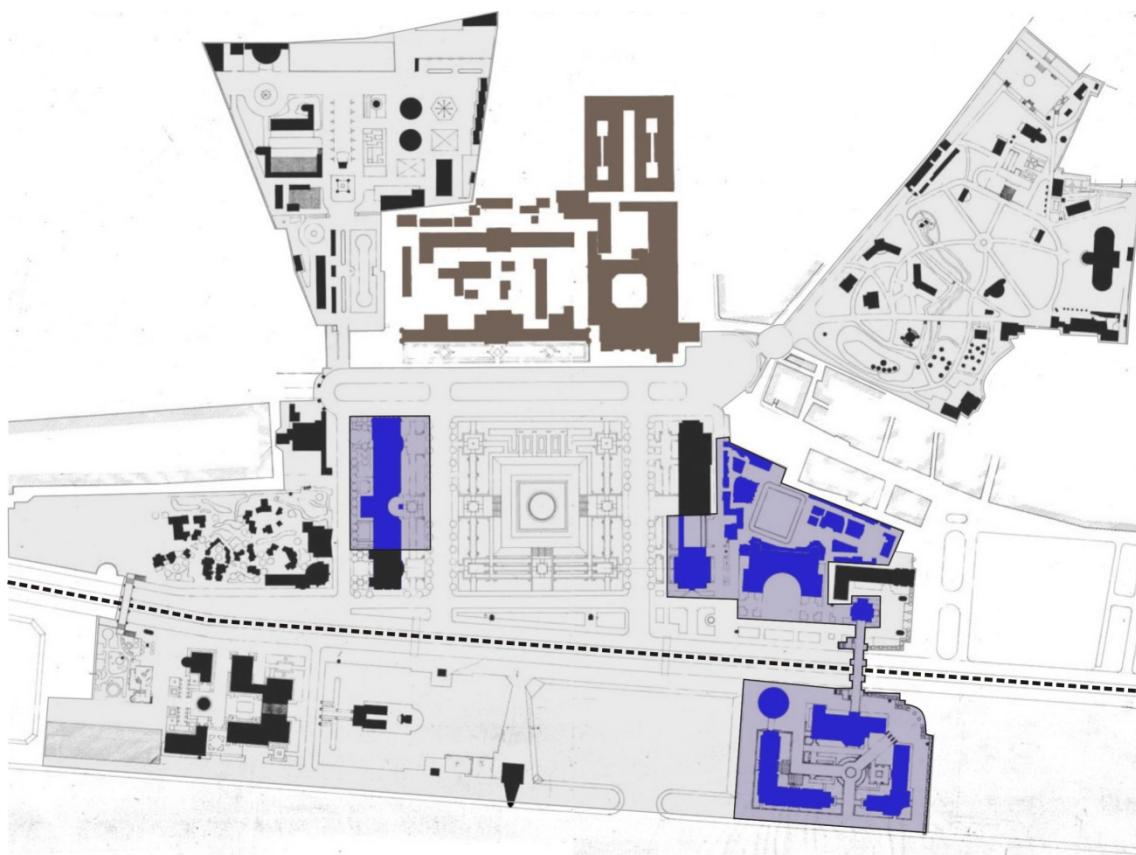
| PLANTA DA EXPOSIÇÃO. NÚCLEO HISTÓRICO.
